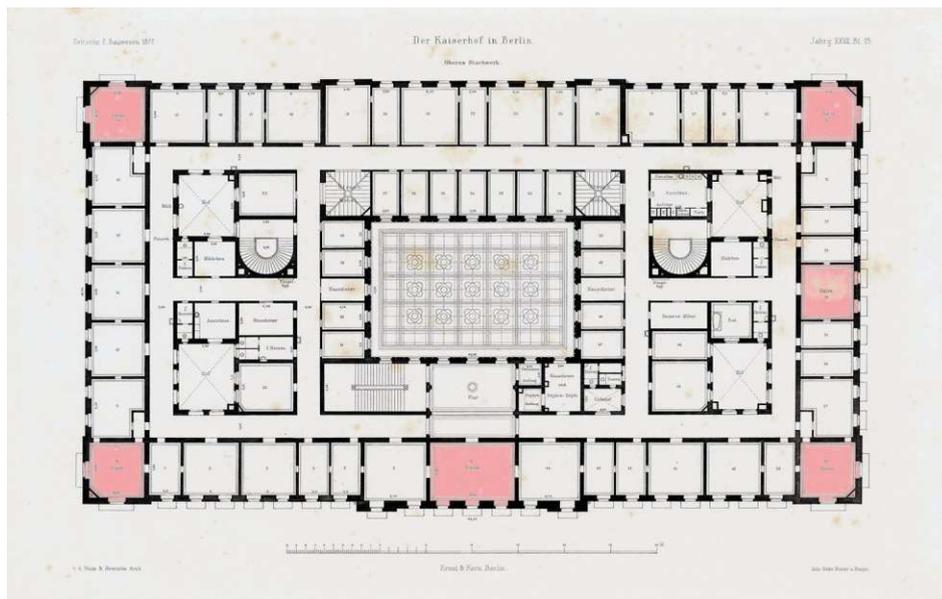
1. Obergeschoss des Hotels Kaiserhof, Berlin, 1875. Architekten: Hude & Henricke. Die Gästezimmer können teils in beliebigen Kombinationen zusammengeschlossen werden. Der Grundriss ordnet sich jenem des Parterre unter. Private Salons sind farblich markiert.
